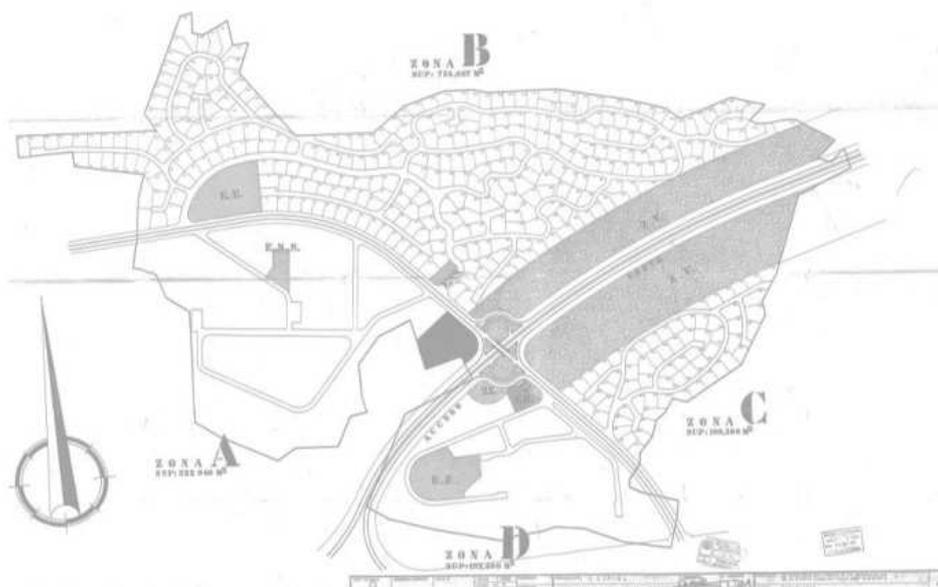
Plan Parcial Ciudad Elegida Juan XIII Fuente: plan parcial original
